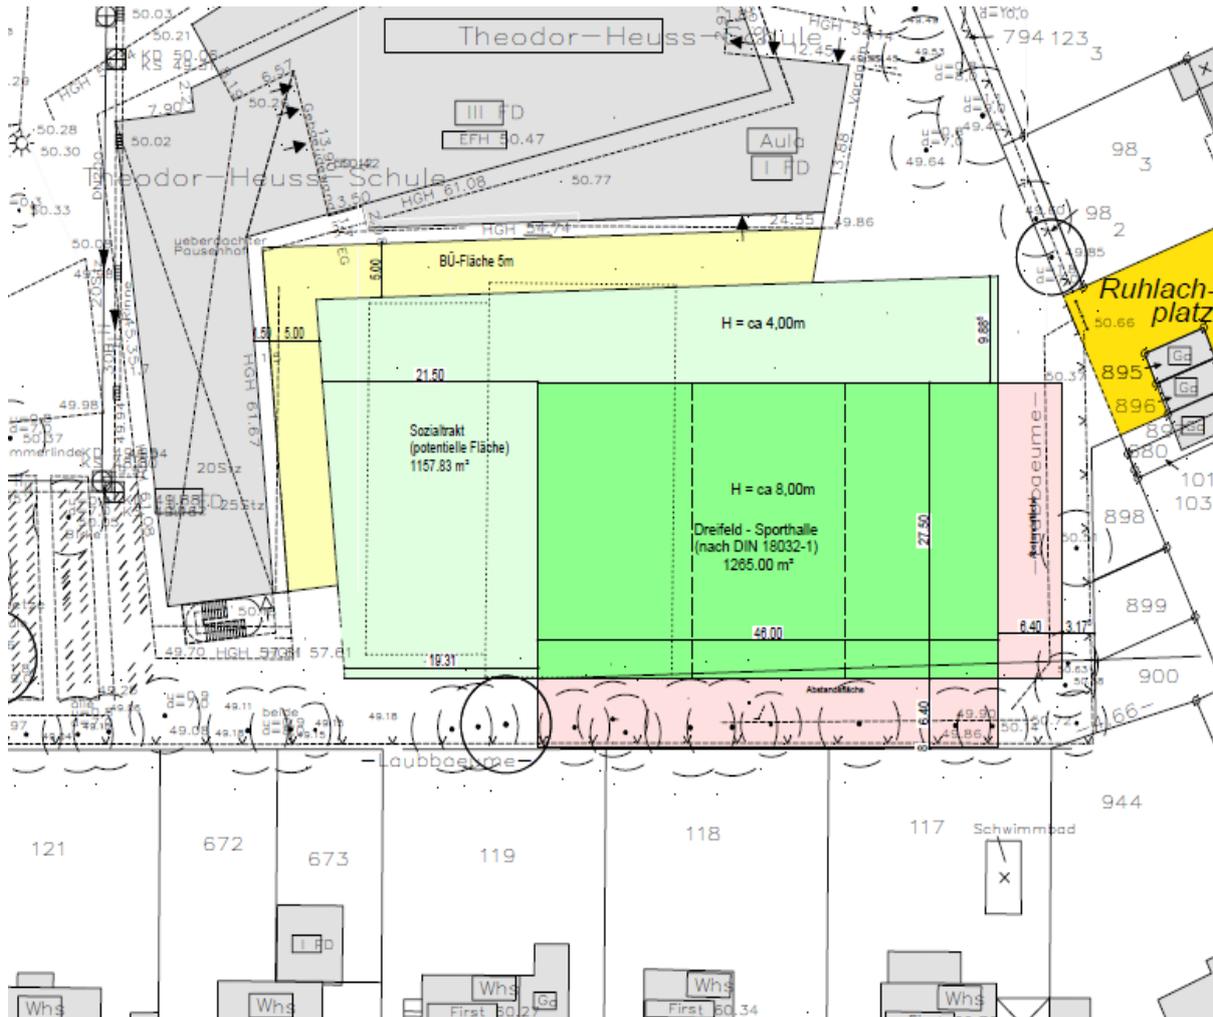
Flächenlayout Variante B (Neubau einer Dreifeld-Sporthalle)
